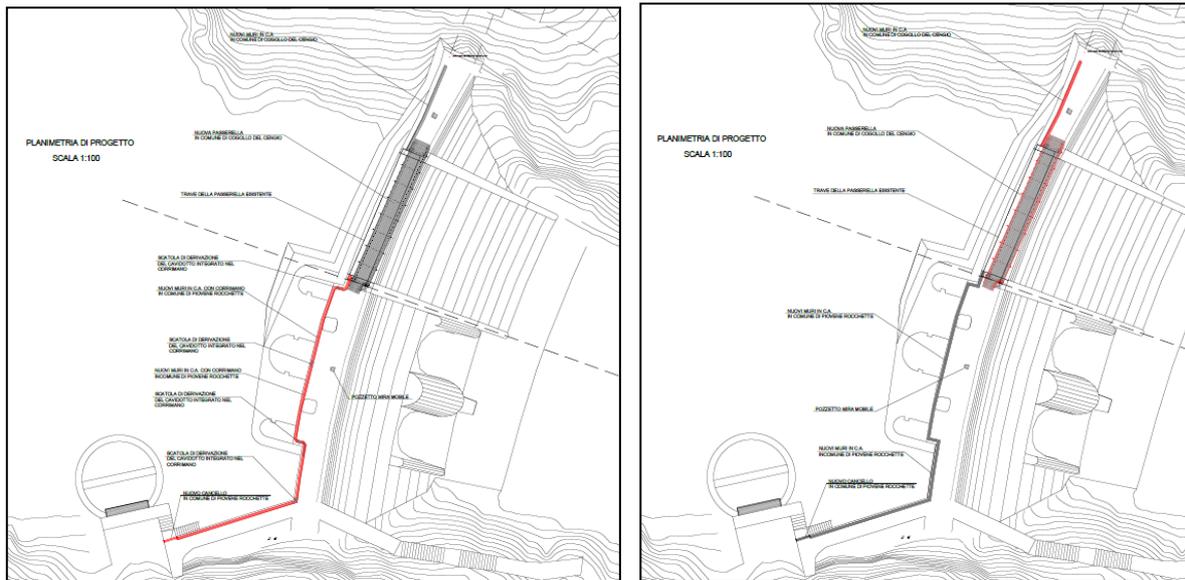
planimetria di progetto della diga con evidenziati in rosso il muro paraonda e la nuova passerella sopra lo sfioratore
